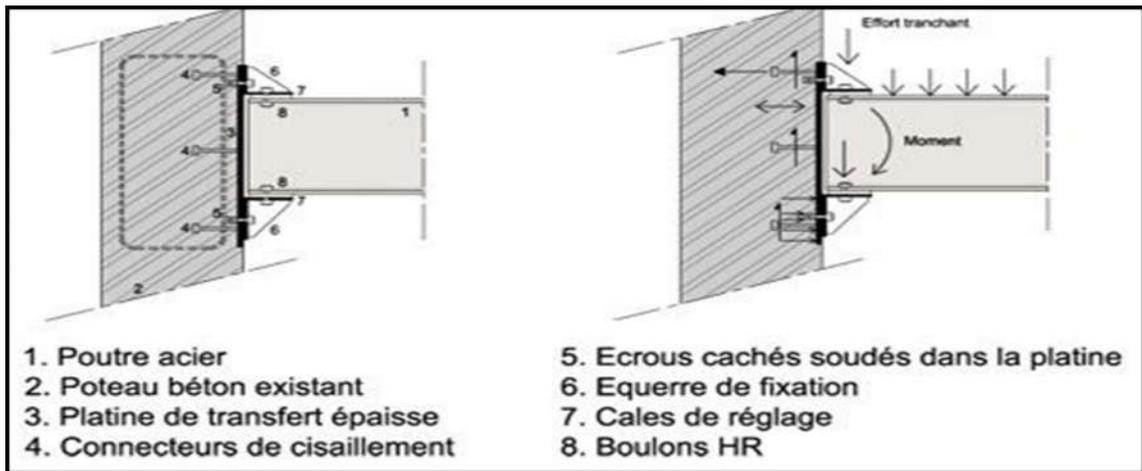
Jonction poutre métallique et poteau. Source : www.arcelormittal.com
